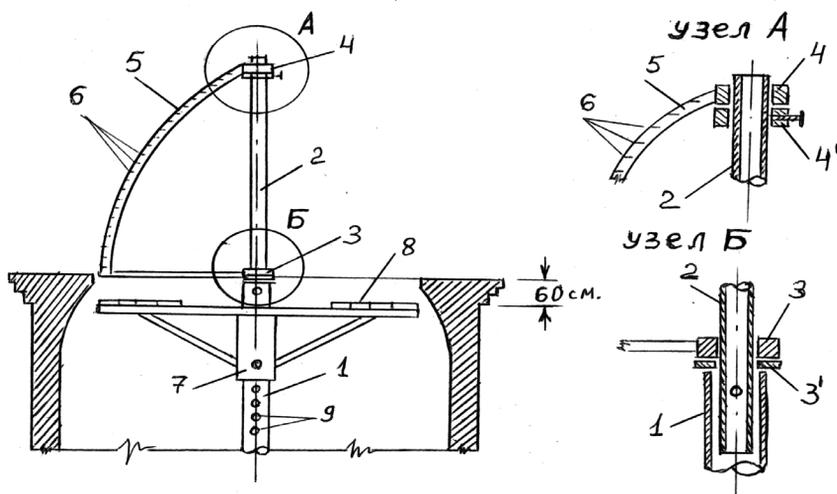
Приспособления для кладки купола, уступами, по копиру, без кружала: 1 - основная труба-стойка; 2 - дополнительная труба для шаблона-копира; 3, 4 - соответственно верхнее и нижнее кольца для крепления копира; 5 шаблон - копир; 6 - риски для кладки рядов - колец; 7 - опорная труба подмостей; 8 - настил подмостей; 9 - отверстия для ступенчатого подъёма подмостей; 3' и 4' - шайбы.
